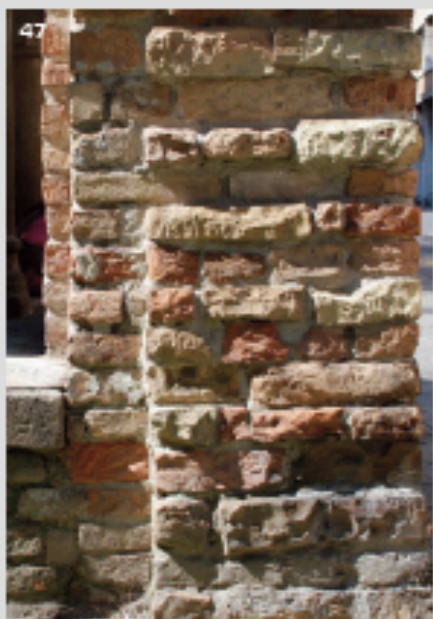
San Pietro, prospetto esterno nord: particolare della tecnica muraria.
